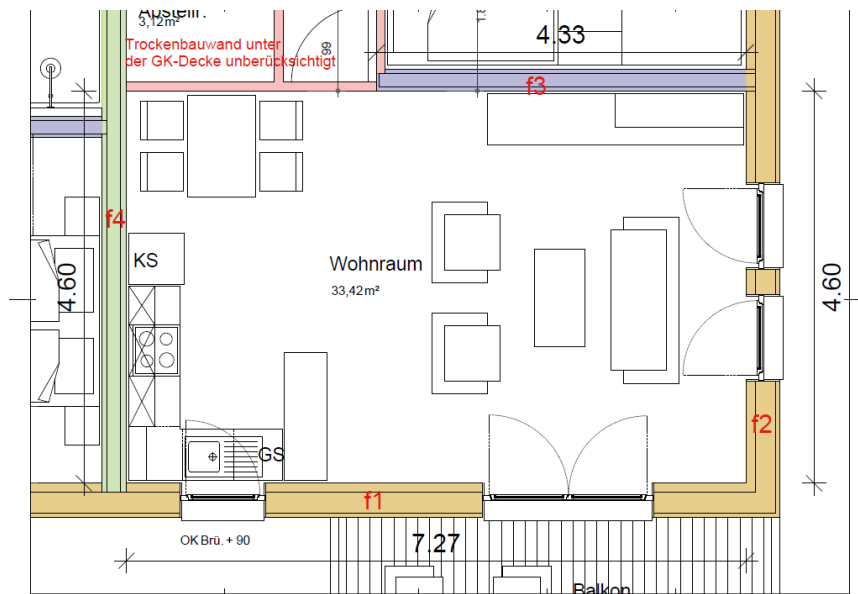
Grundrissssituation 2.OG zu 1.OG (Grundrisse deckungsgleich)
